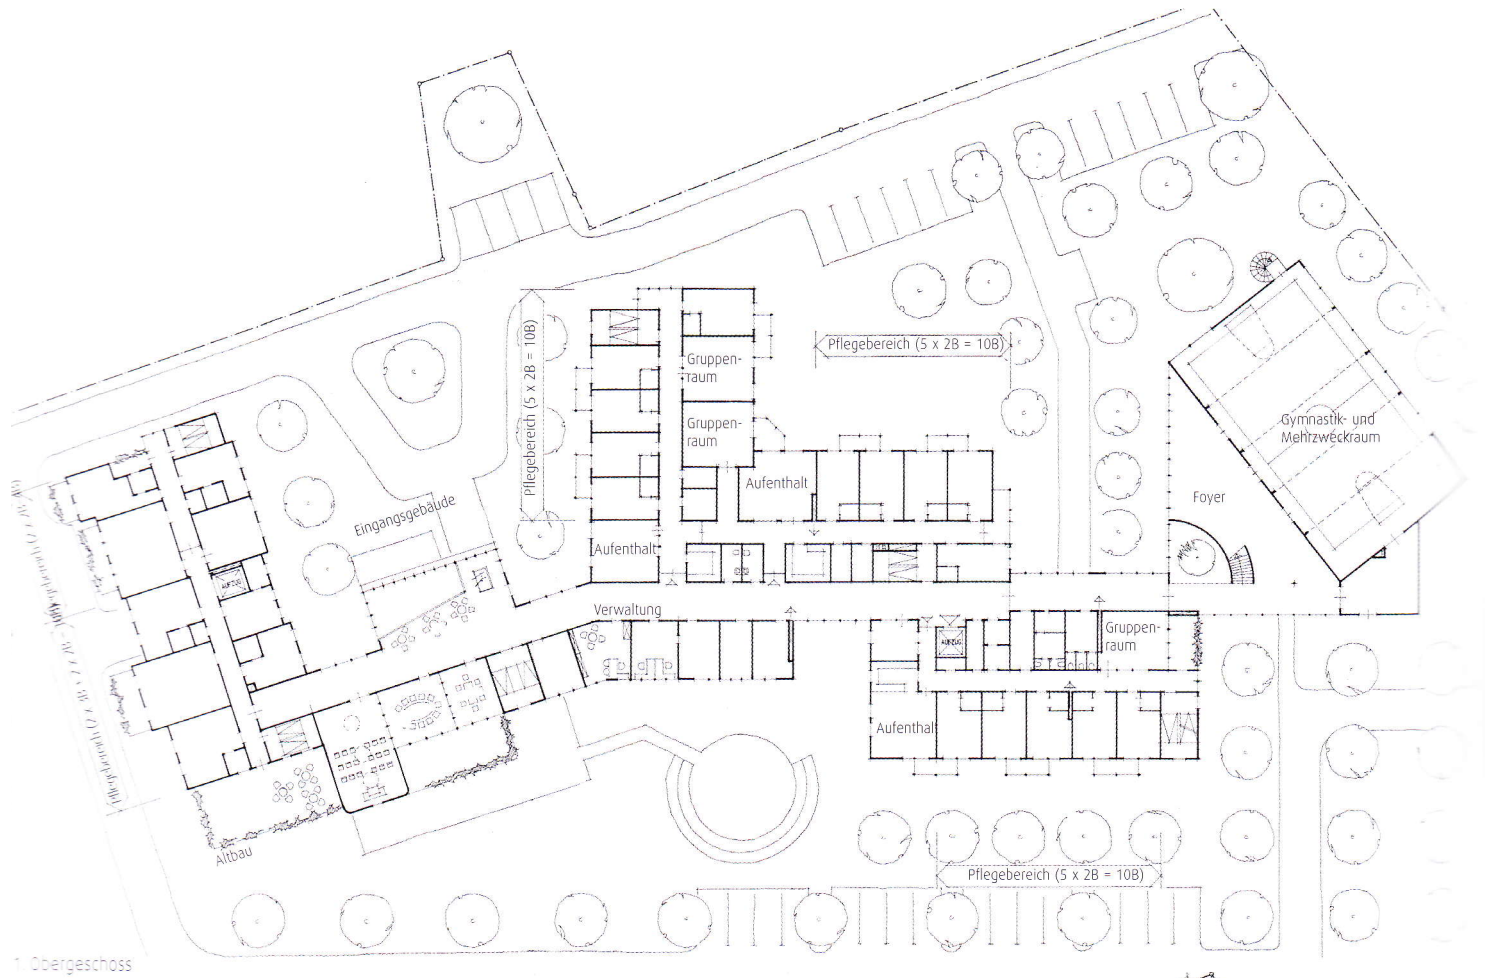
RJ Planungsbüro Fachklinik Klosterwald, Grundriss 1.OG, M 1:700
